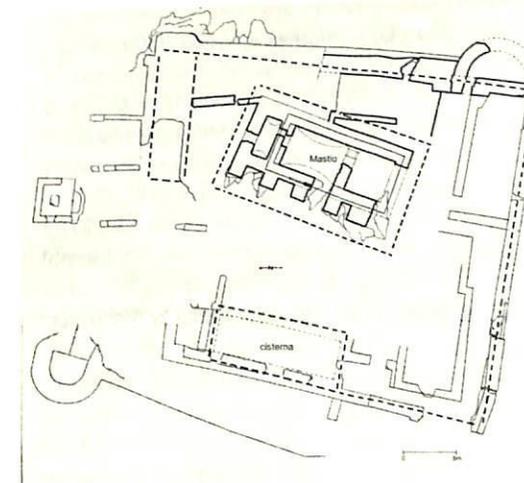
San Giorgio Morgeto (RC). Planimetria del castello. Il rettangolo interno racchiude le strutture di prima fase, la linea a tratto le strutture di seconda fase.
